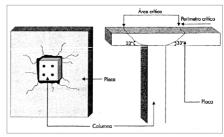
Fisuras por Punzonamiento Fuente: Investigación
